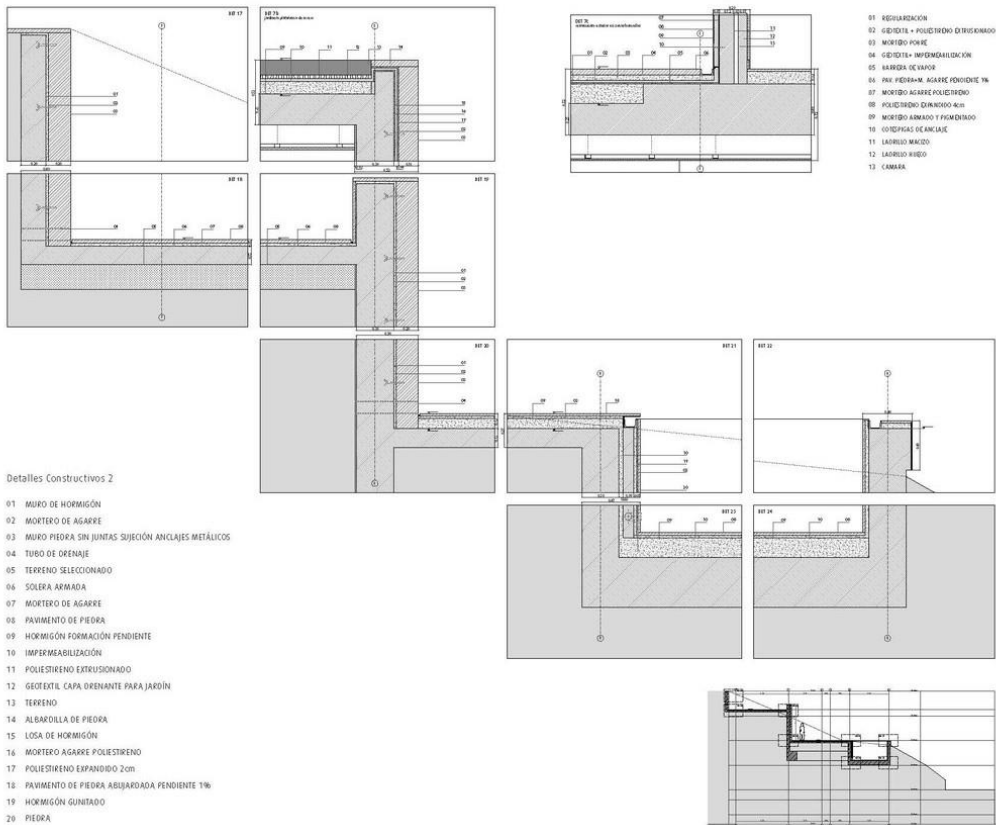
Sección constructiva 01. Fuente: Fran Silvestre Arquitectos.
